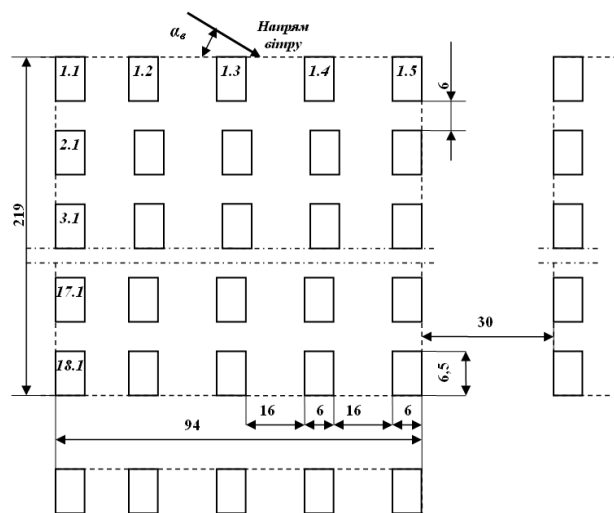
План кварталу складу круглих лісоматеріалів штабельного зберігання
